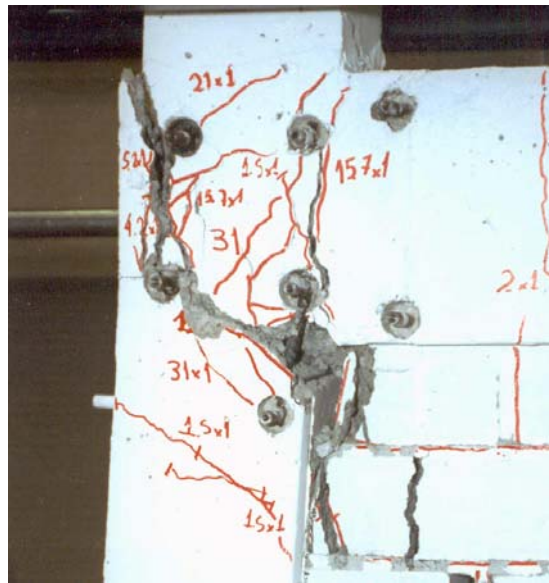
Falla de corte en columna (Crisafulli, 1997)
